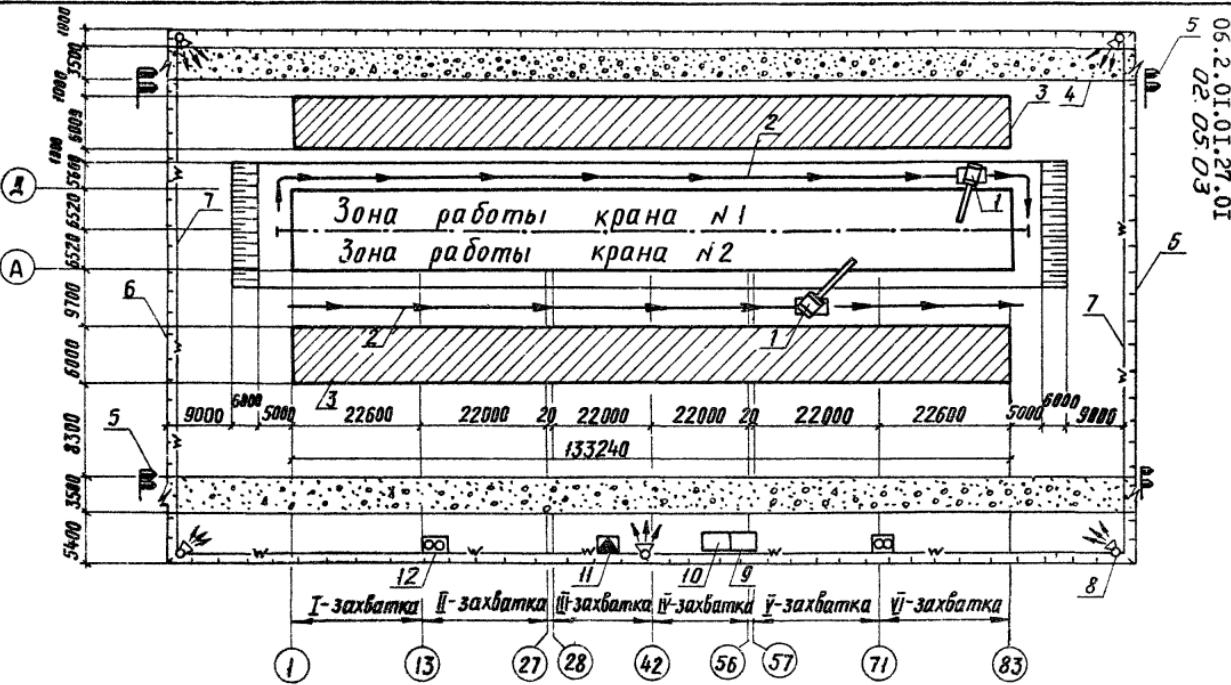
Рис. I. Схема организации строительной площадки: I-краны К-16I; 2-оси проходов кранов; 3-площадки складирования материалов и конструкций; 4-временный проезд; 5-знаки: "Берегись автомобилей" и "Посторонним вход воспрещен"; 6-временное ограждение; 7-кабель 380В; 8-прожекторная машина; 9-бытовое помещение; 10-конторы производителя работ; II-трансформаторная подстанция КППН-180; 12-туалет
